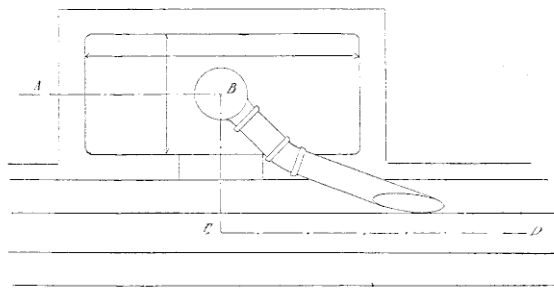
Réservoir de chasse latéral à l'égout. (Plan.)
